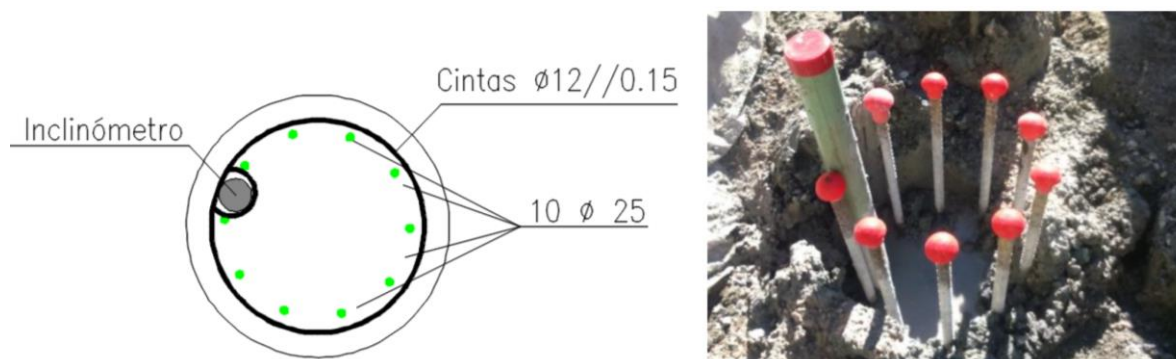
Localização dos inclinómetros no interior da estaca, planta e aplicação prática [35].
